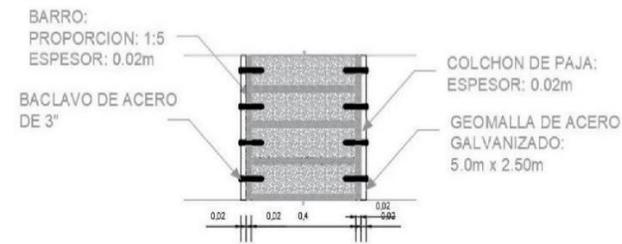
Detalles técnicos constructivos del acabado en muros.
